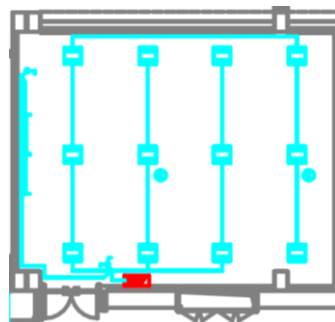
Planta autocad da Sala D.01.11B-P2.
